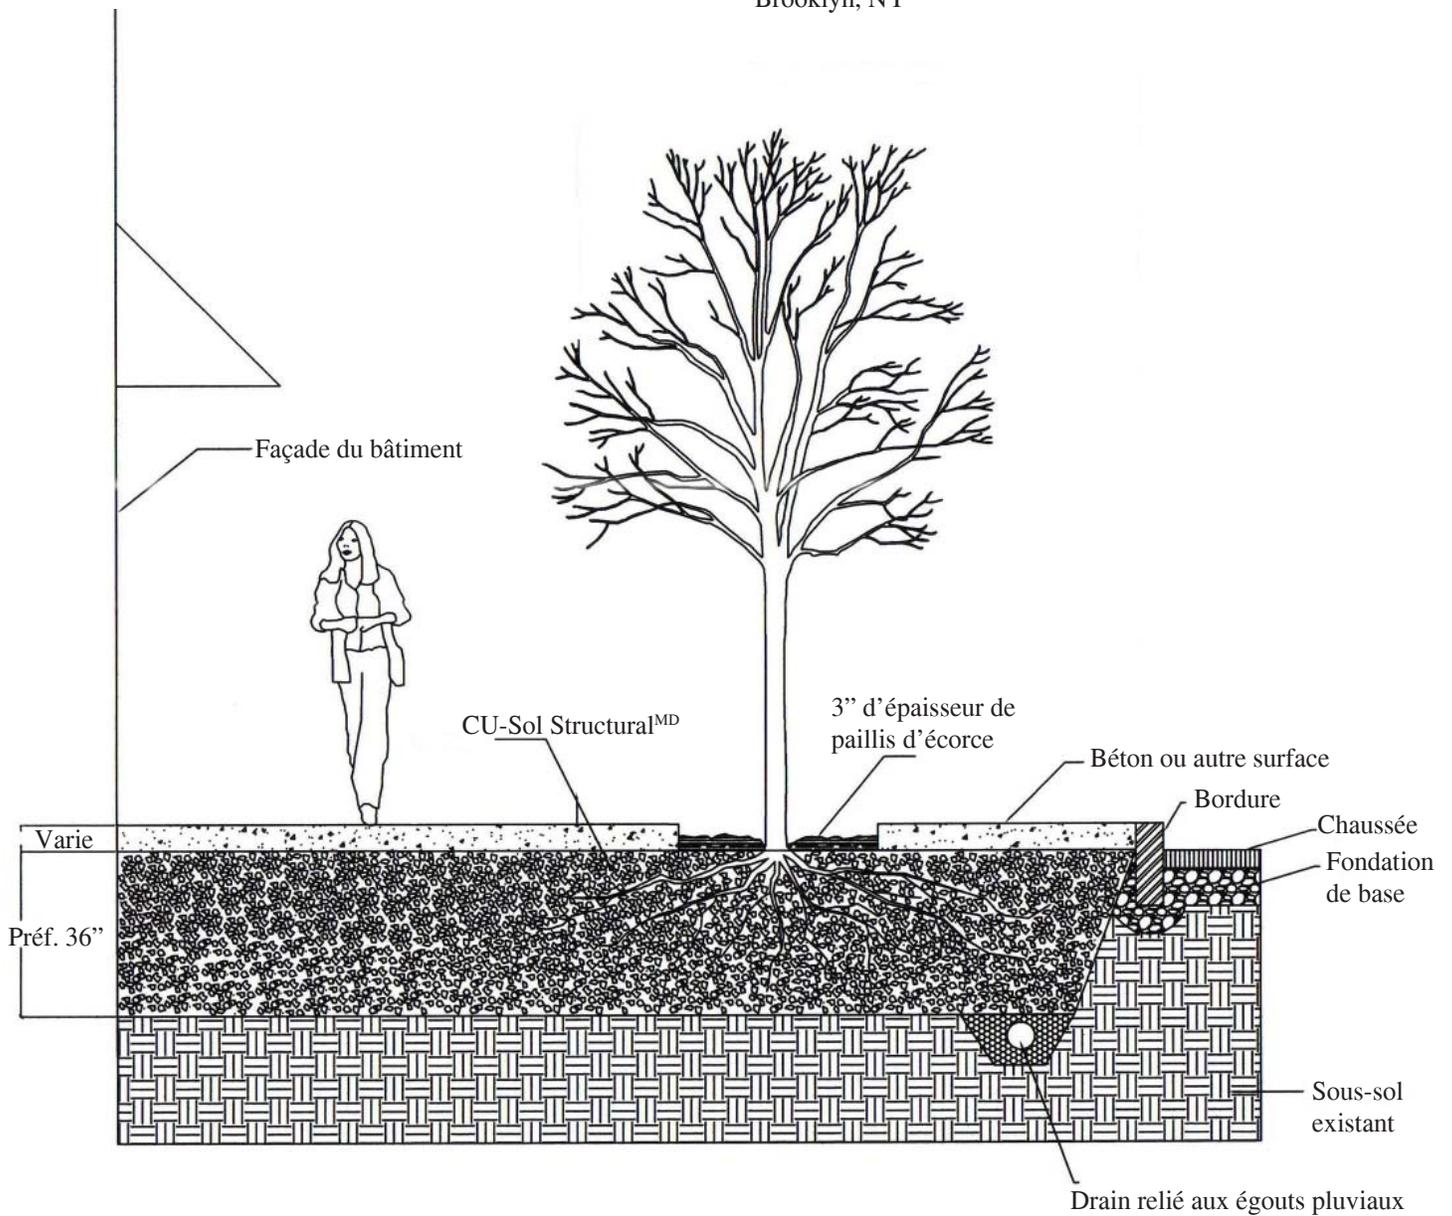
Détail typique d'une plantation d'arbres de rue avec CU-Sol Structural^{MD}
